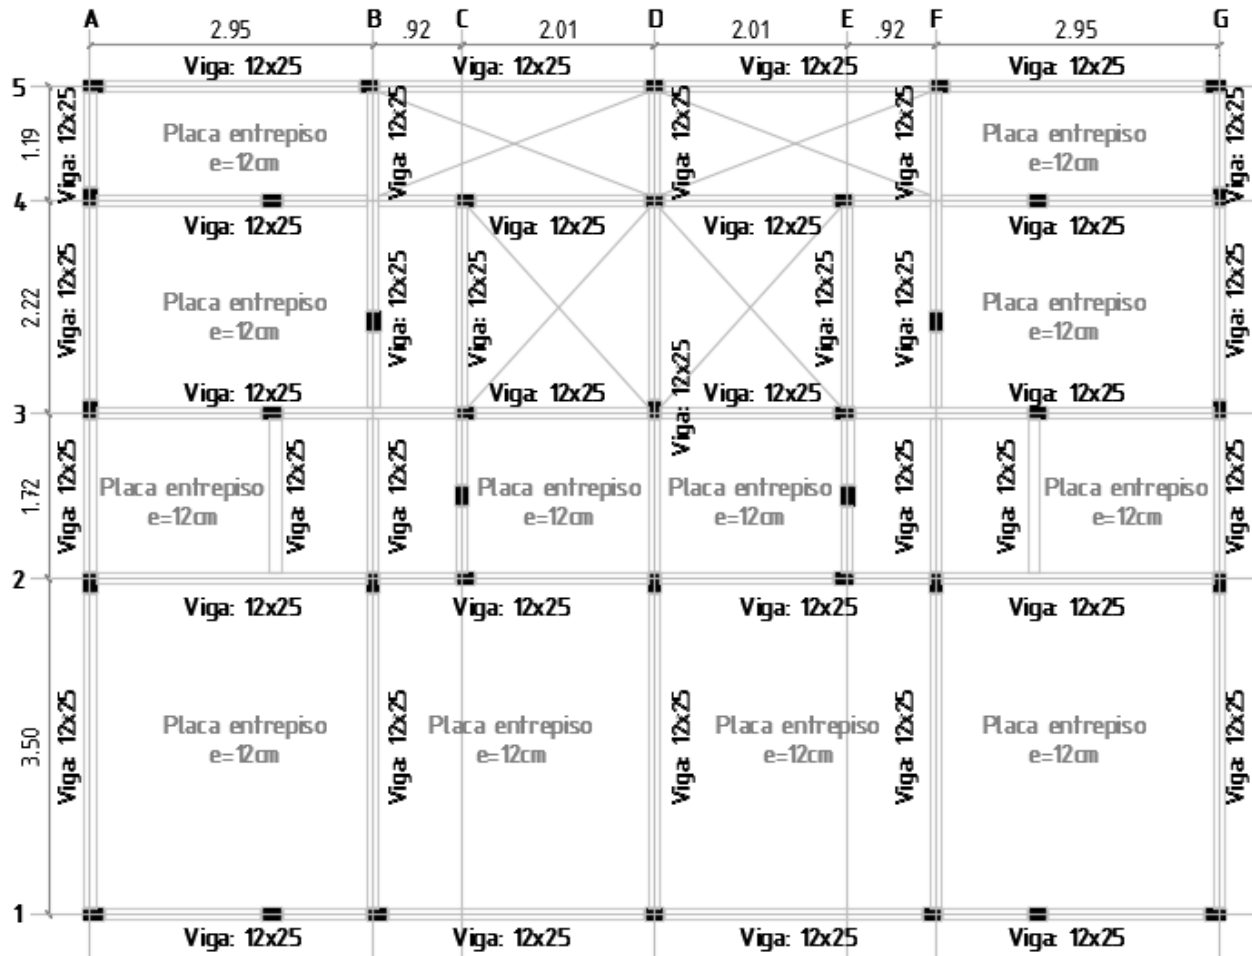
Configuración en planta de vigas de amarre a nivel de entrepiso
